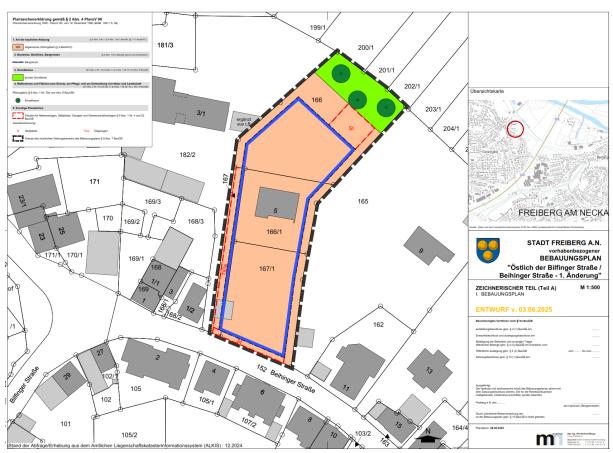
Geltungsbereich Bebauungsplan Stand Mai 2025.
